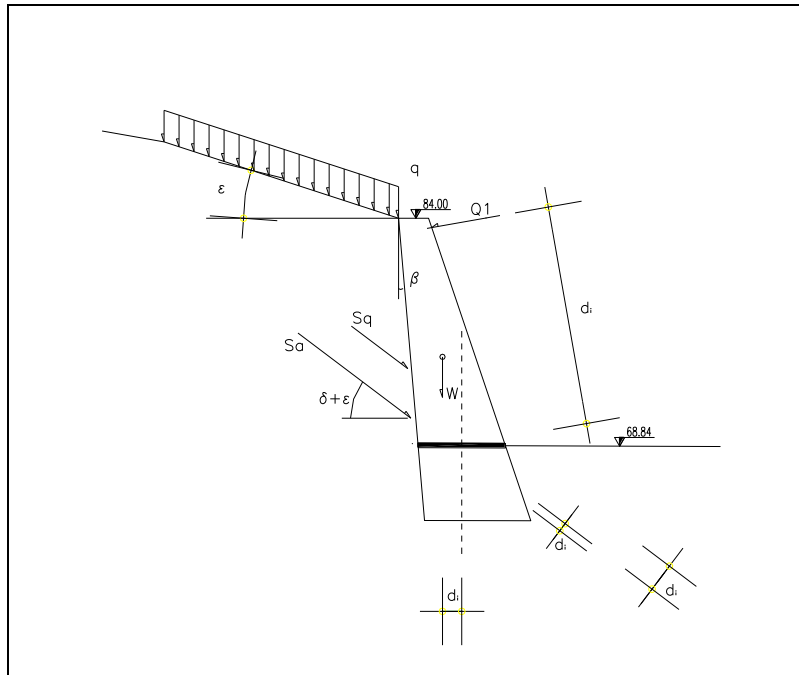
Schema di calcolo con indicazione delle forze agenti e dei rispettivi bracci rispetto alla sezione di verifica – caso statico
